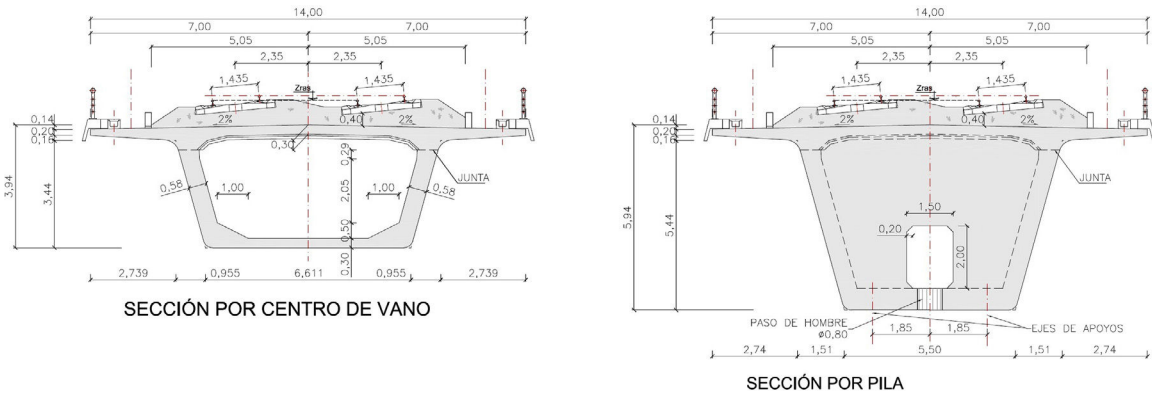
Secciones transversales tipo de centro de vano (izquierda) y por zona sobre pilas (derecha).
